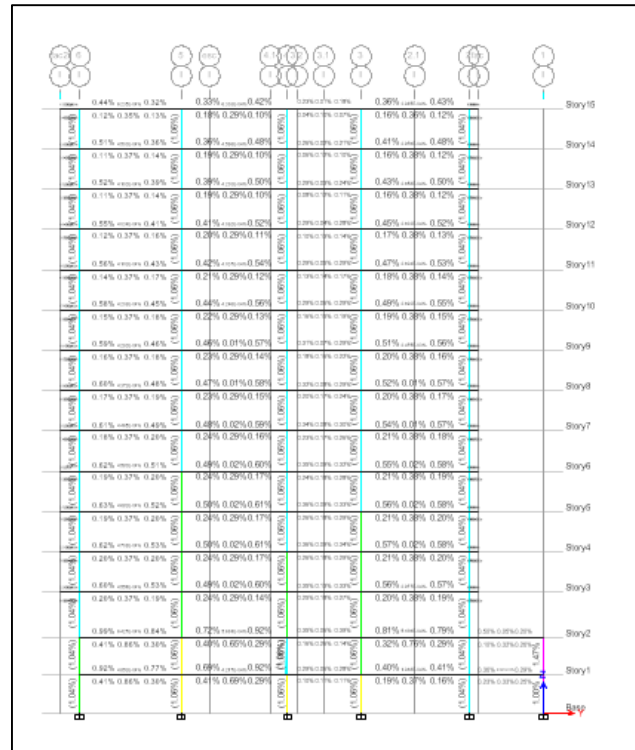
Diseño de secciones de concreto reforzado en etabs, acero de refuerzo eje I.
